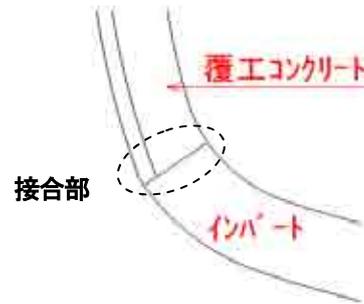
一般的なインバートと覆工コンクリートとの接合部断面図
